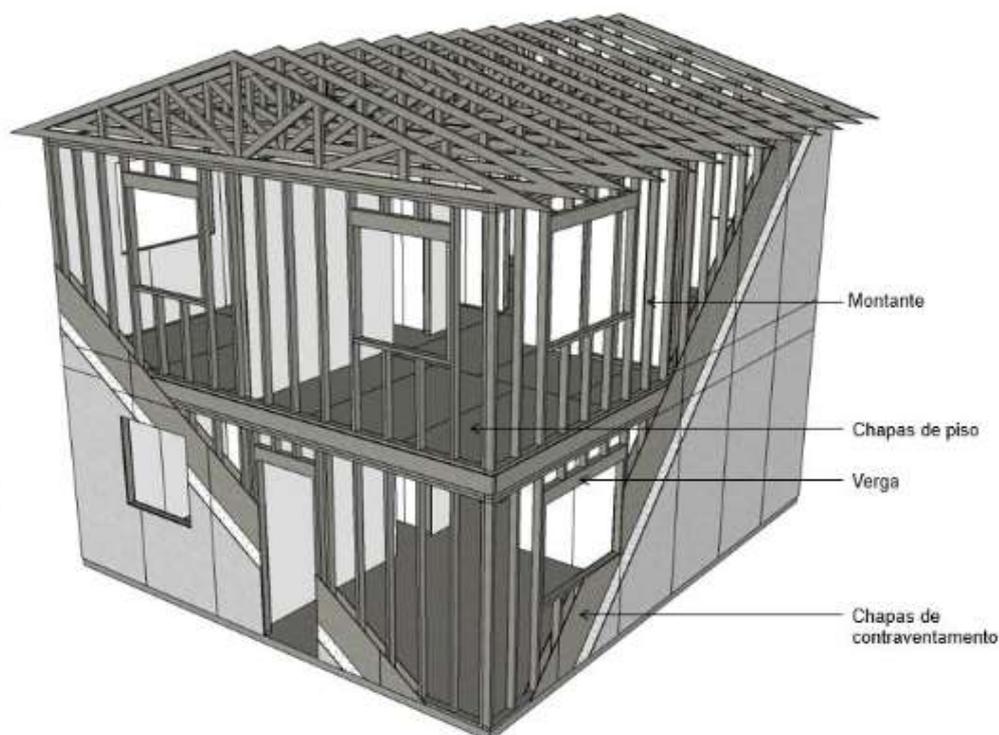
Esquema 3D de uma edificação de dois pavimentos em *light wood frame
